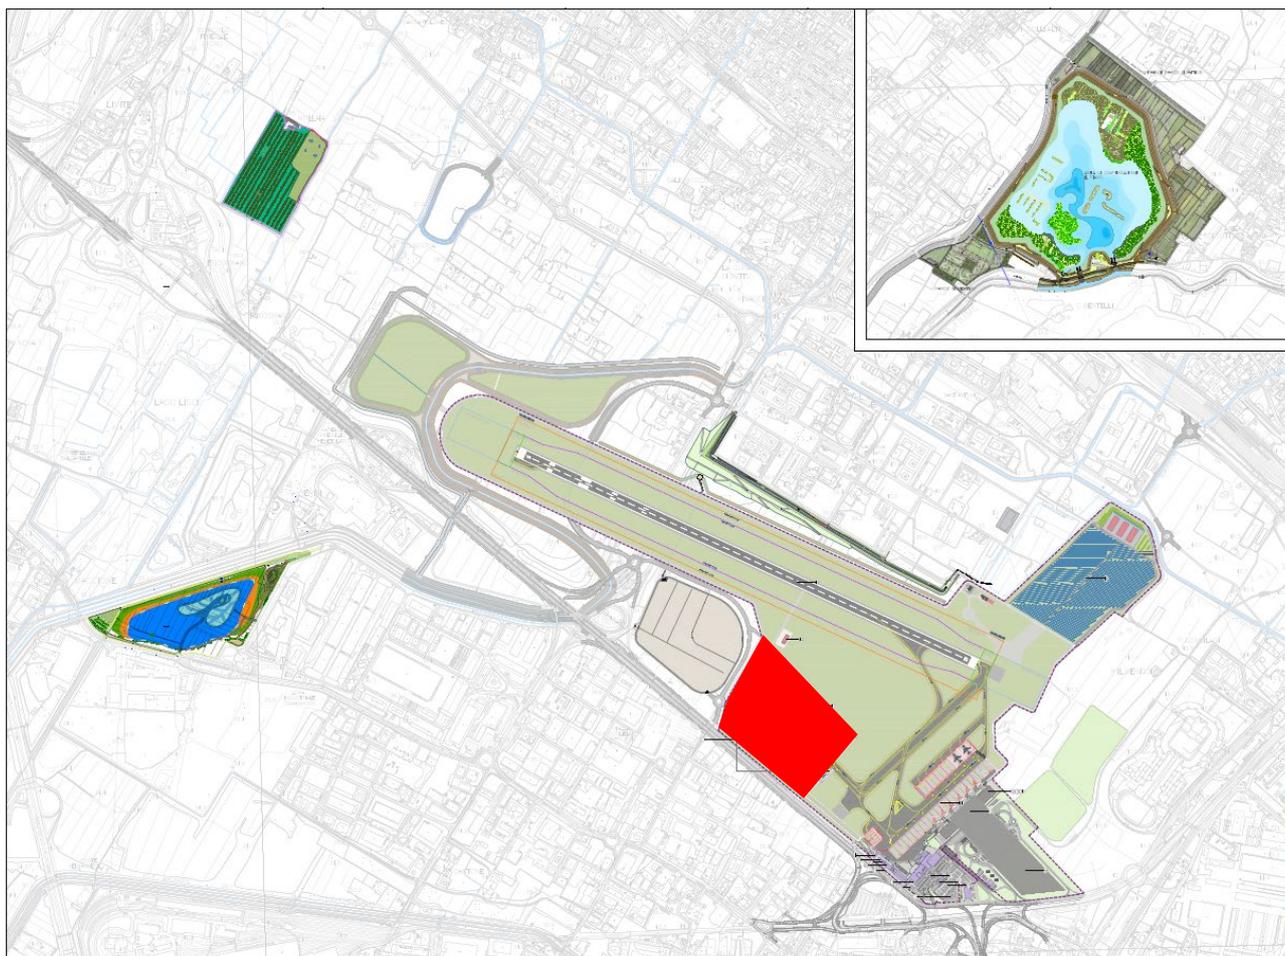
Ipotesi Masterplan con individuazione dell'area Ovest
